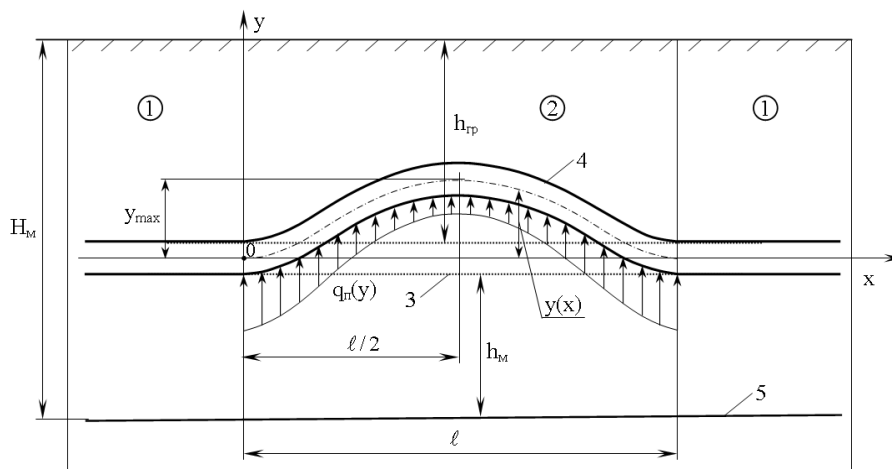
Расчетная схема силового взаимодействия подземного газопровода с пучинистым грунтом: 1 — непучинистый грунт; 2 — пучинистый грунт; 3 — начальное положение газопровода; 4 — участок деформировавшегося газопровода; 5 — фронт промерзания грунта
